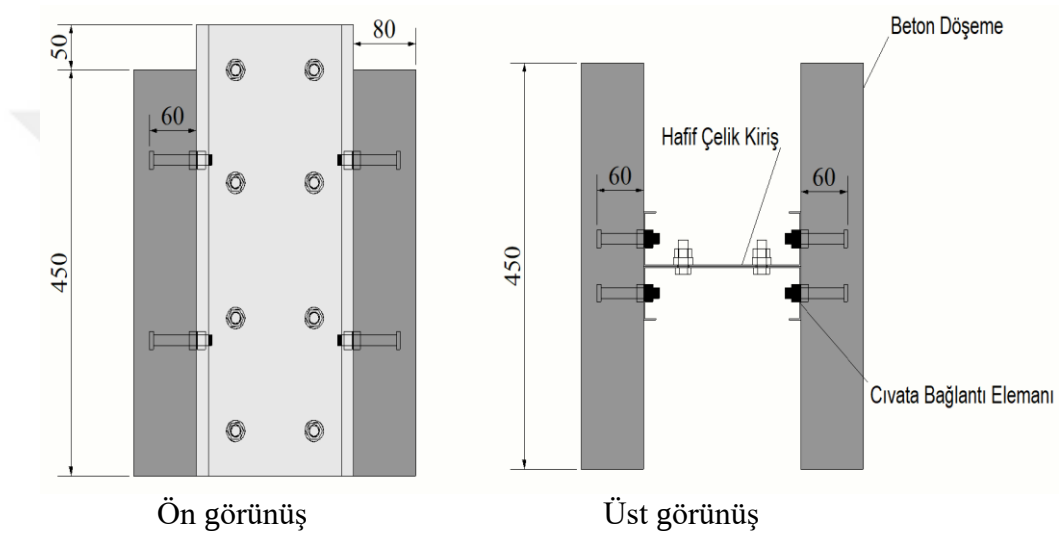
PO-B deney elemanlarında kiriş bağlantı detayı
